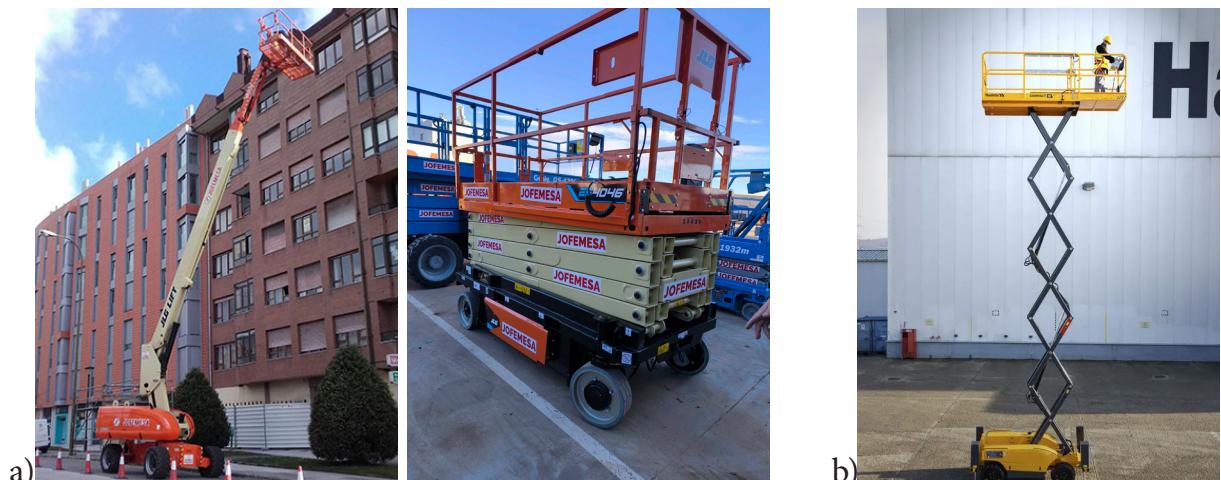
Plataformas elevadoras móviles de personal (PEMP) / Cesta elevadora
